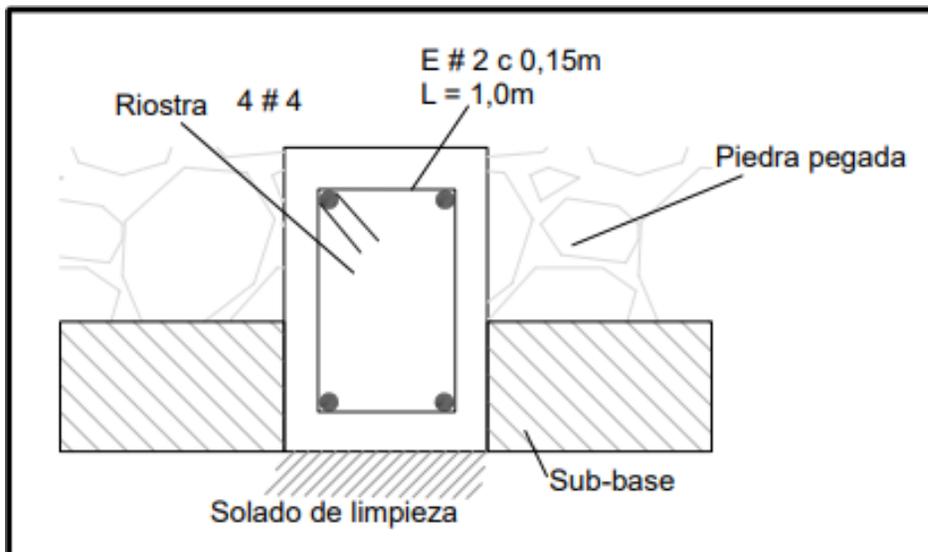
Corte Transversal Sección en Piedra Pegada
